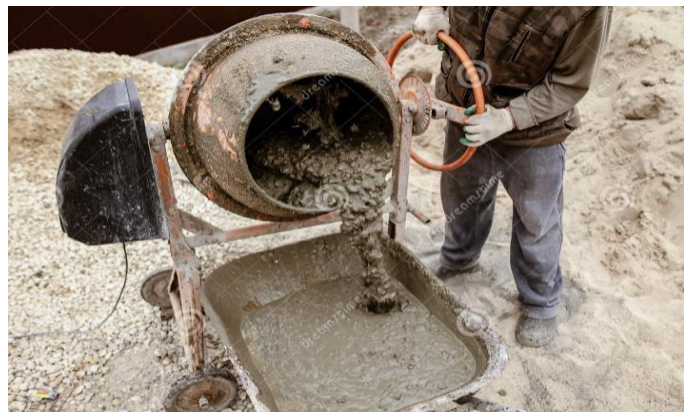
TIPOS DE CONCRETOS FABRICADOS EN OBRA.
